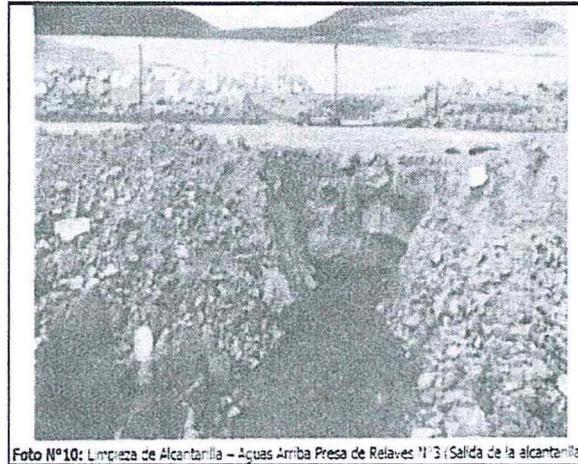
Limpieza de Alcantarilla – Aguas Arriba Presa de Relaves N° 3 (Salida de la alcantarilla)
